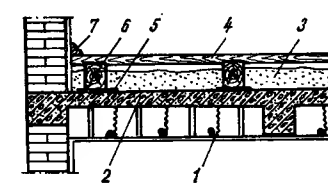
Pardoseală din lemn la planșee de beton armat:
